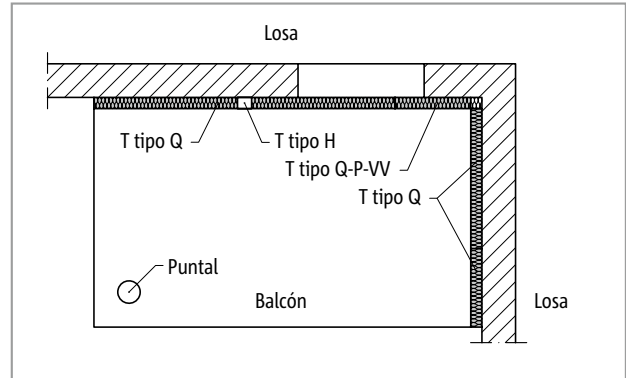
Schöck Isokorb® T tipo Q, Q-P-VV: Balcón con apoyo en dos lados con puntal y fuerzas transversales ascendentes
